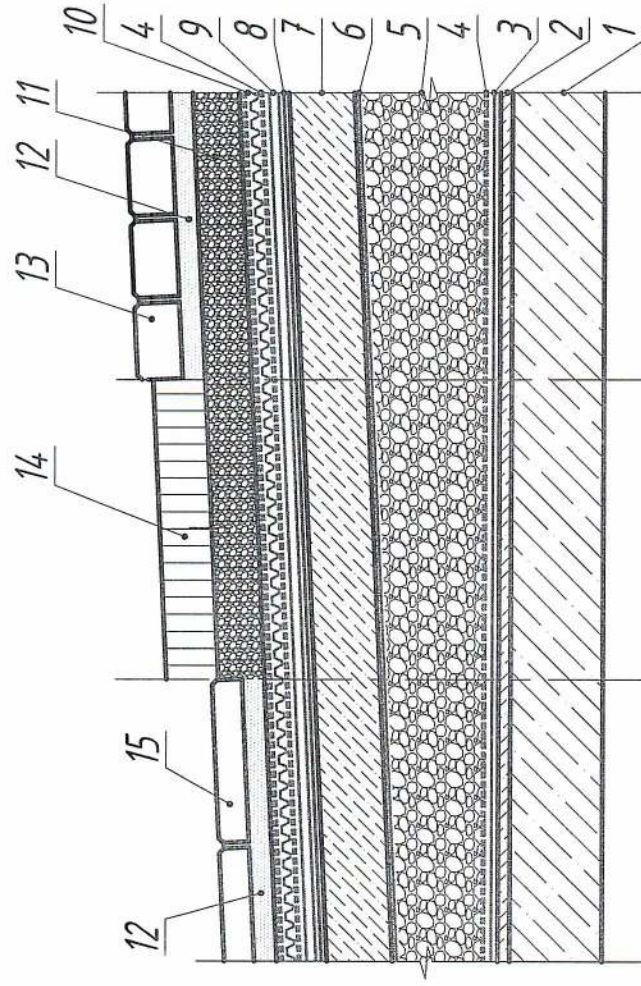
Принципиальная схема конструктивного исполнения настила бесчердачного покрытия выполняемого по железобетонному основанию (эксплуатируемая кровля под автомобильную нагрузку)
